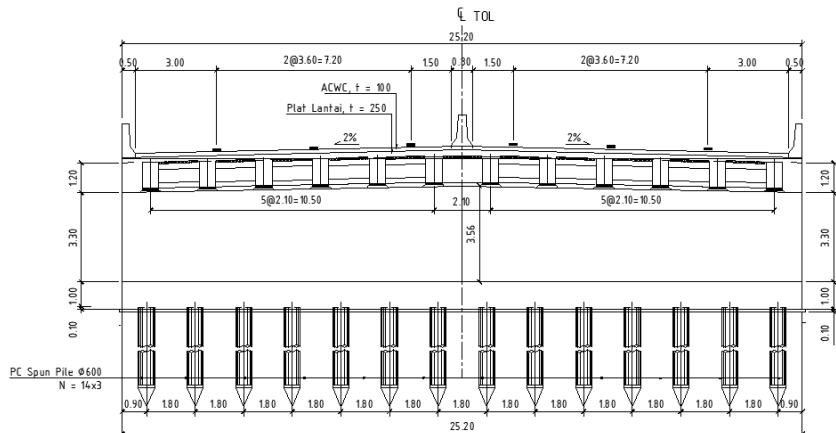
8 Desain Rencana Memanjang Jembatan
